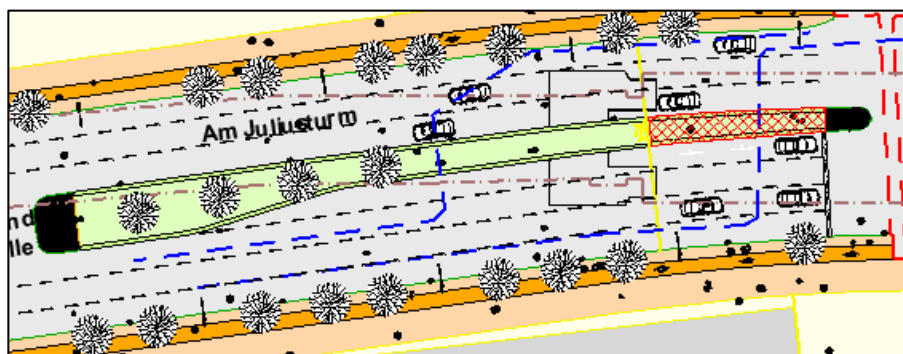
Ausschnitt Grundlageplan Bestand (unmaßstäblich)
